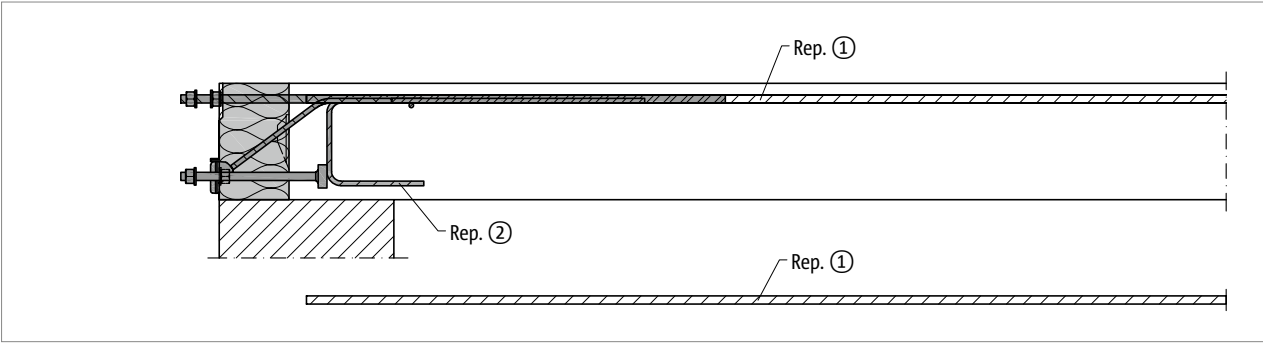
Schöck Isokorb® XT type SK-M1 : armatures à prévoir par le client, vue en coupe
